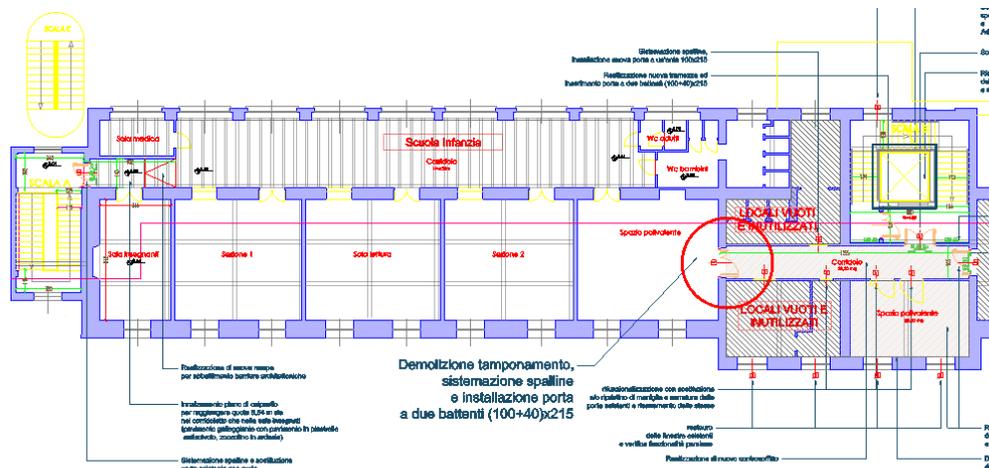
Stralcio pianta piano secondo con individuazione dell'apertura da realizzare (cerchiata in rosso)
